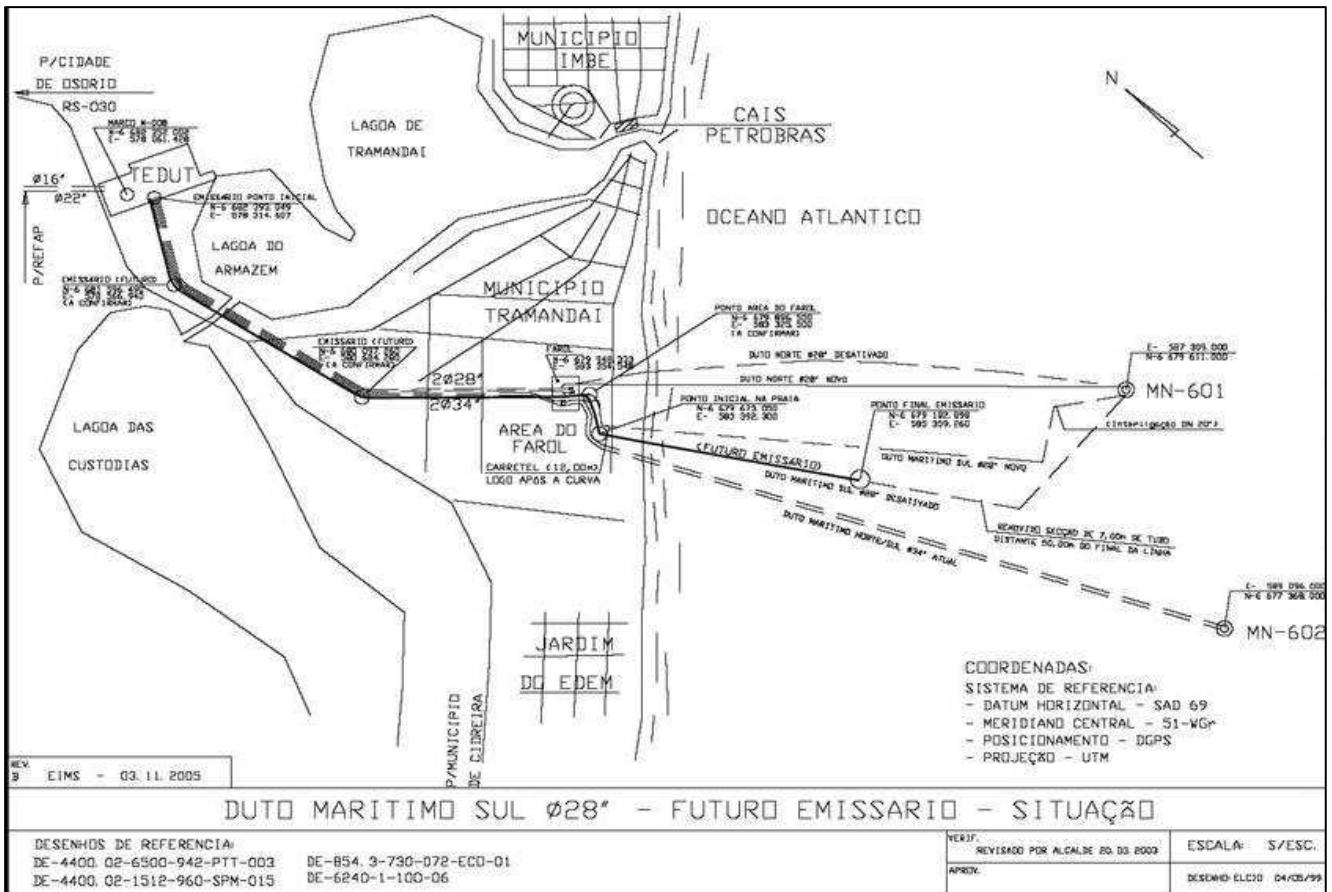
Croqui de situação das instalações e equipamentos do Tedut
